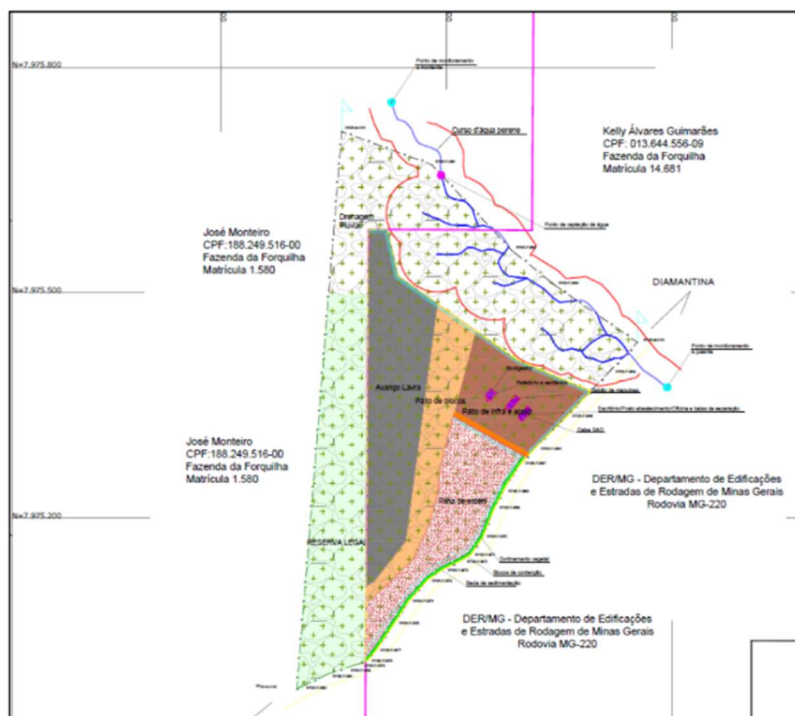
Vista geral da área proposta para instalação do empreendimento
